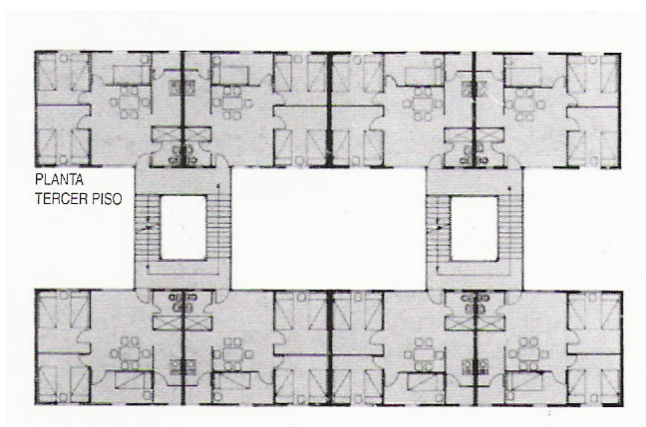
Planta tipo de bloque de vivienda en Población Las Parcelas. Fuente MINVU 2004<sup>a</sup>
